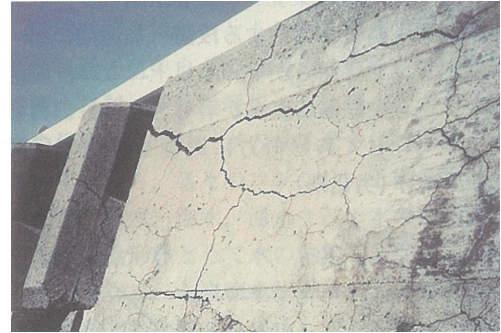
ASRによるひび割れの例¹⁾
